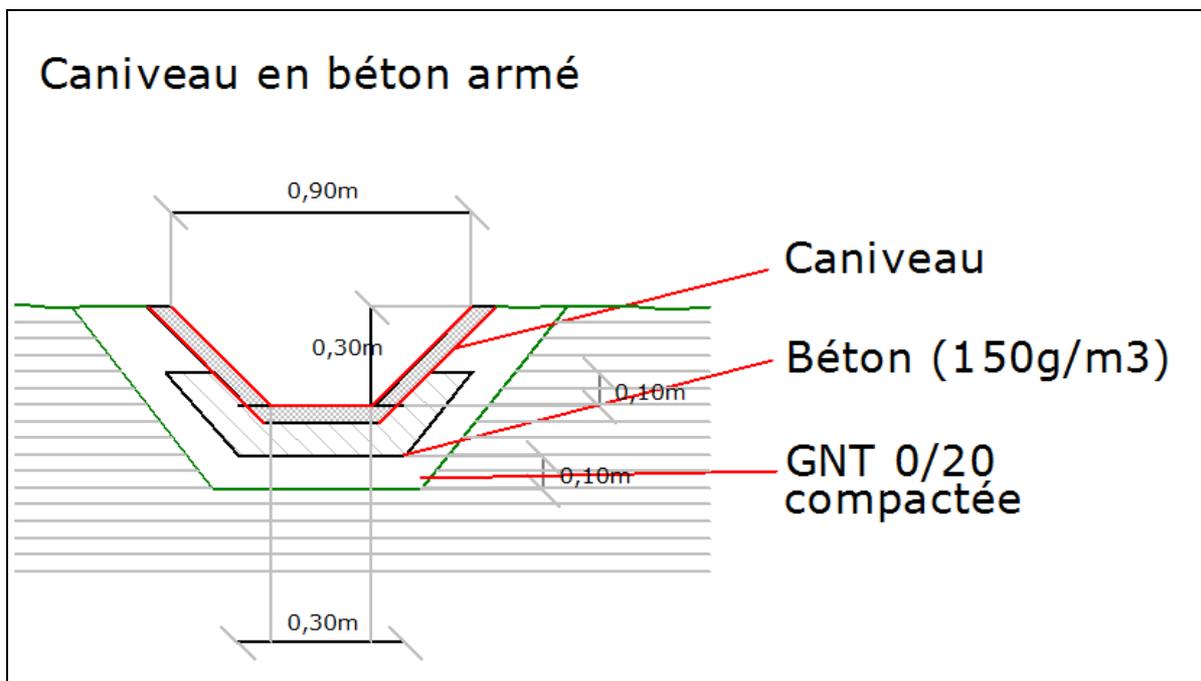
Coupe du caniveau Cd2 en béton préfabriqué
